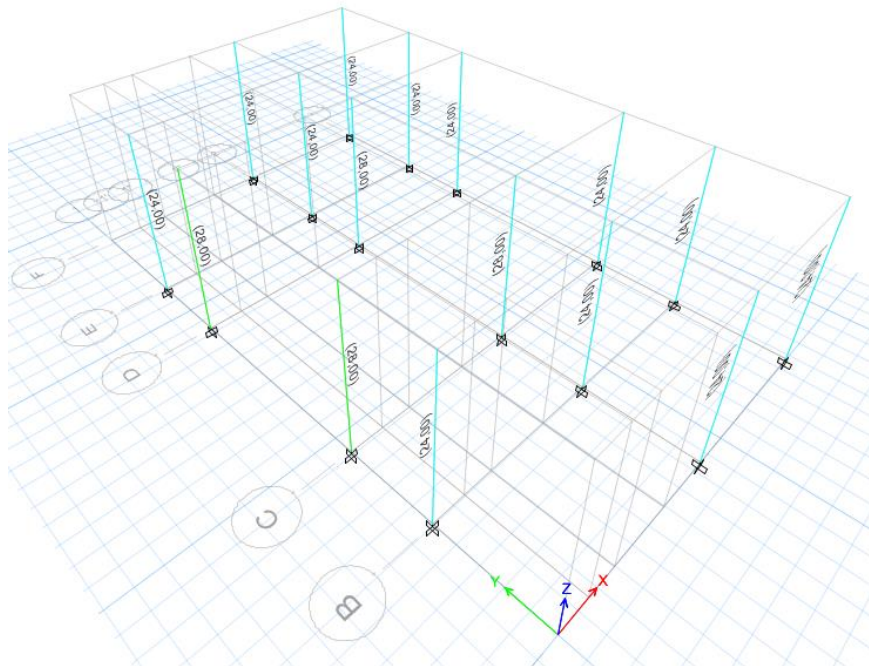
Refuerzo longitudinal columnas en cm²
